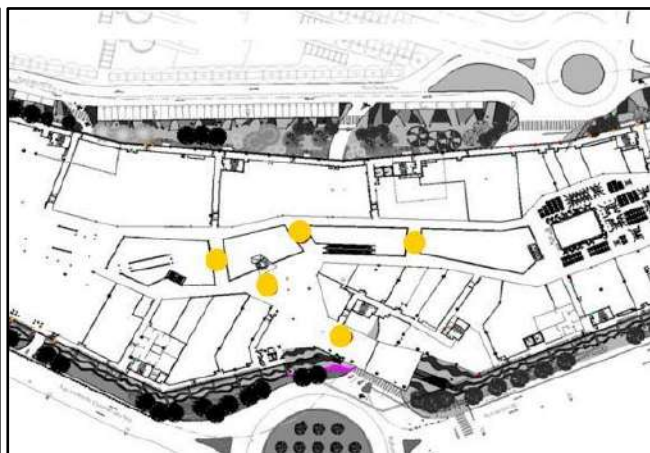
Planta Original fornecida CC Tavira (Piso 1)
